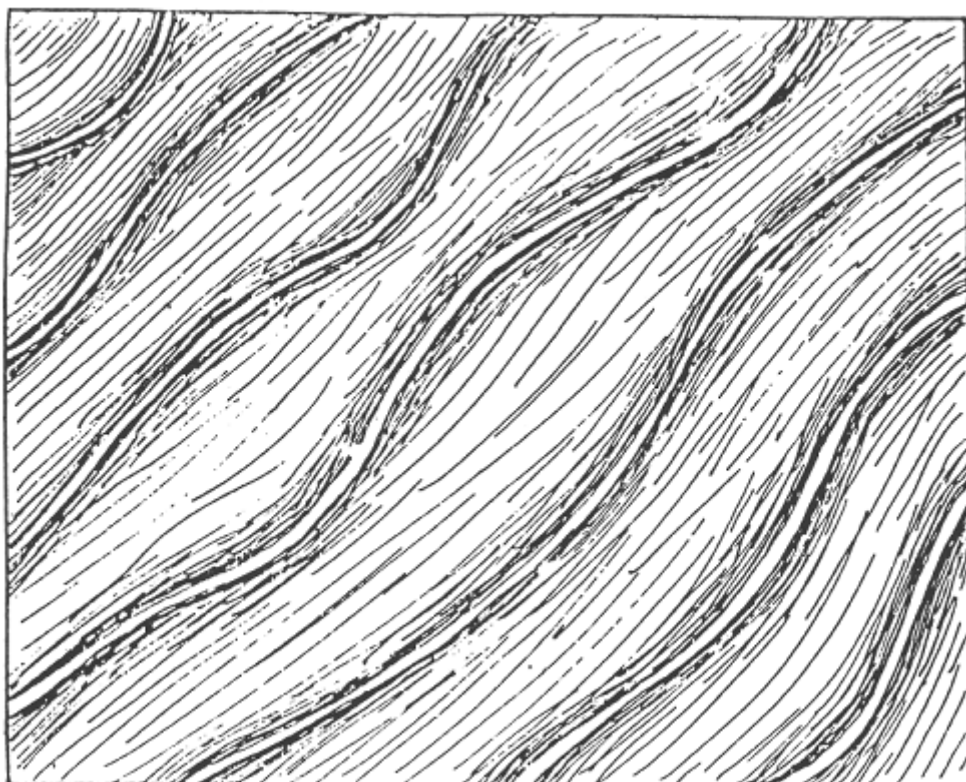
Esquema de construção de terraços em nível ou de retenção
